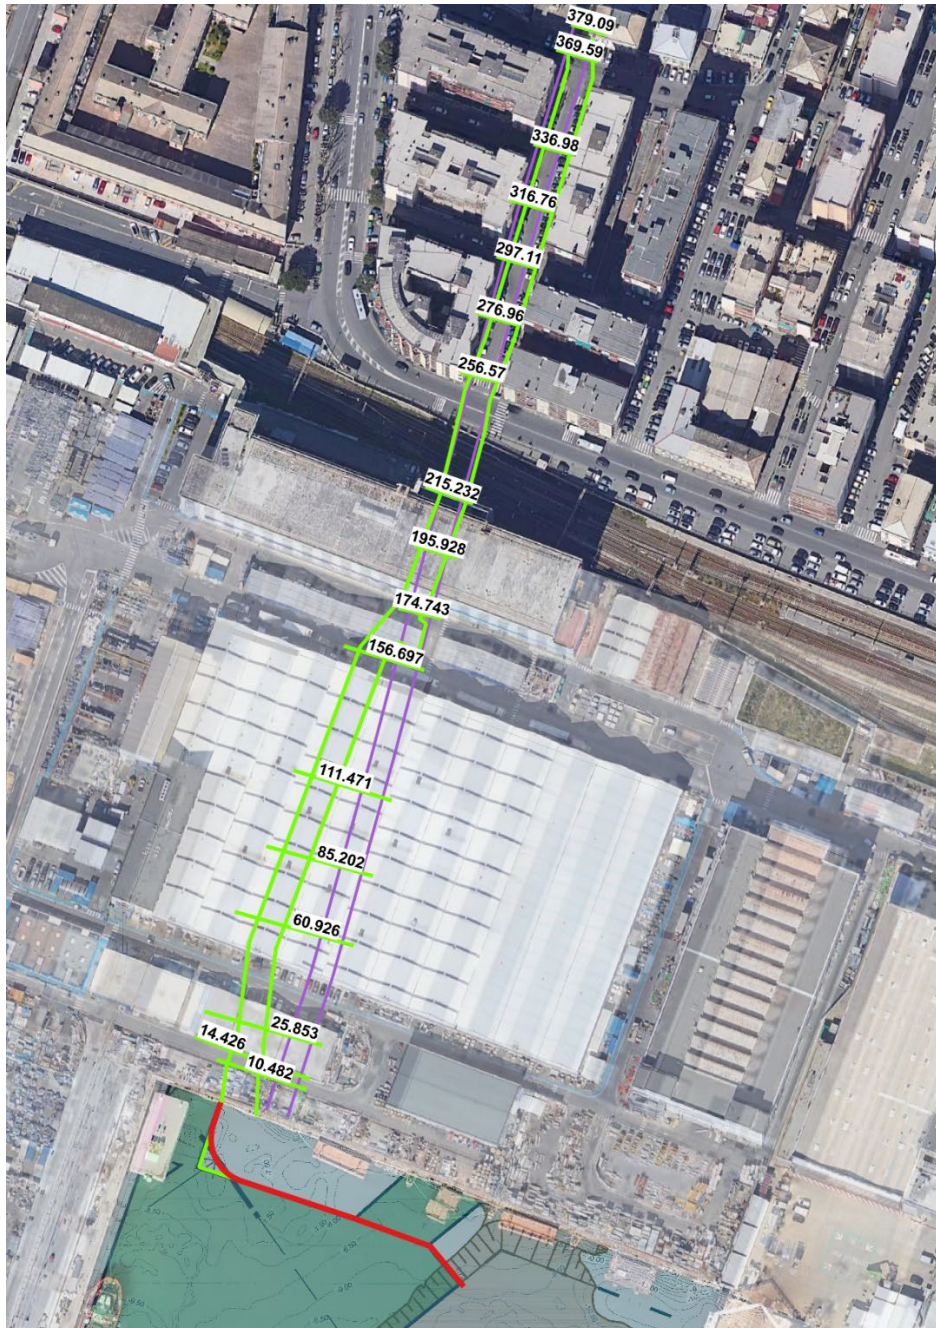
Rappresentazione planimetrica della configurazione di progetto on la progressiva delle sezioni verticali. In viola t. Cantarena attuale, in verde torrente di progetto, in rosso deviatore.
